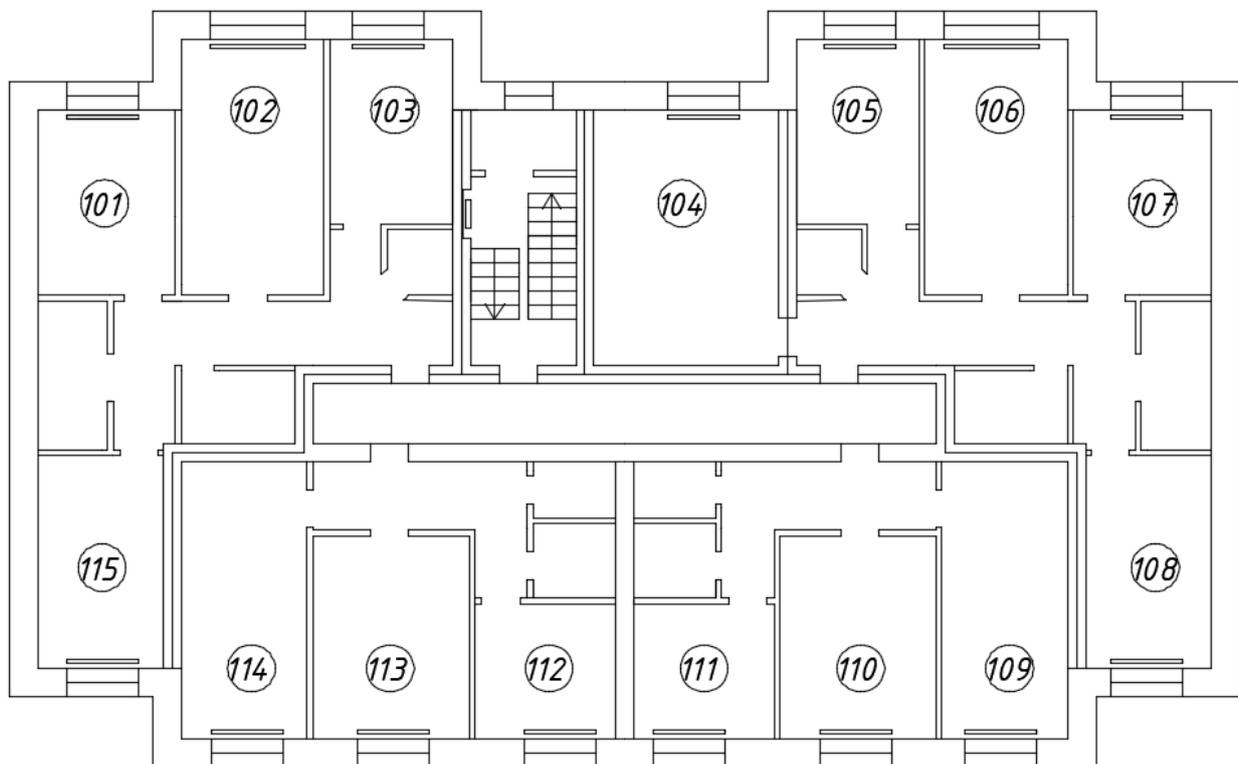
План первого этажа многоэтажного жилого дома с нанесением электрических отопительных приборов
